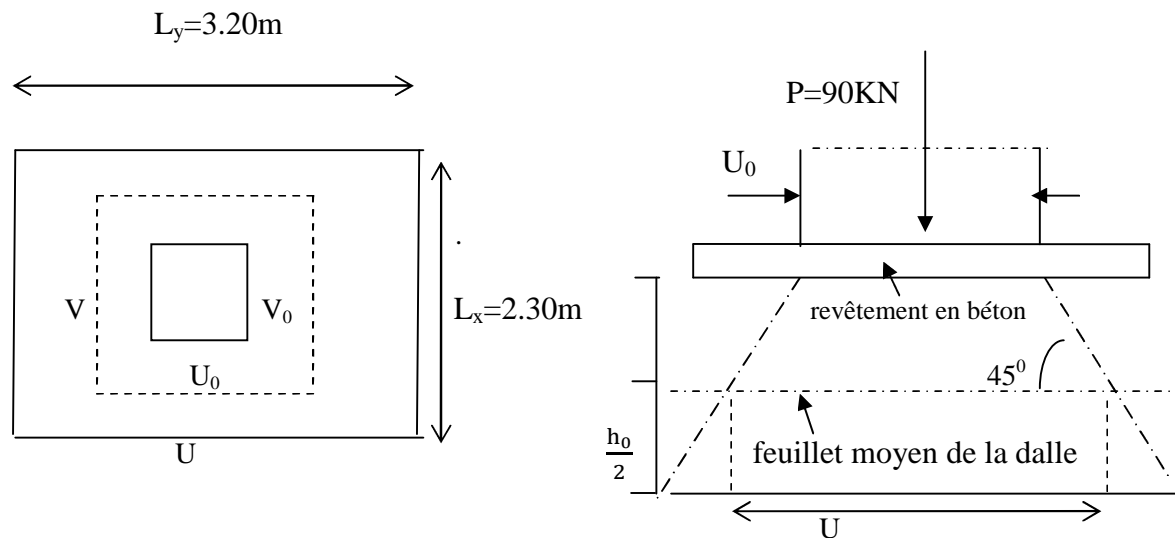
Caractéristiques géométriques de la dalle pleine de la salle machine.
